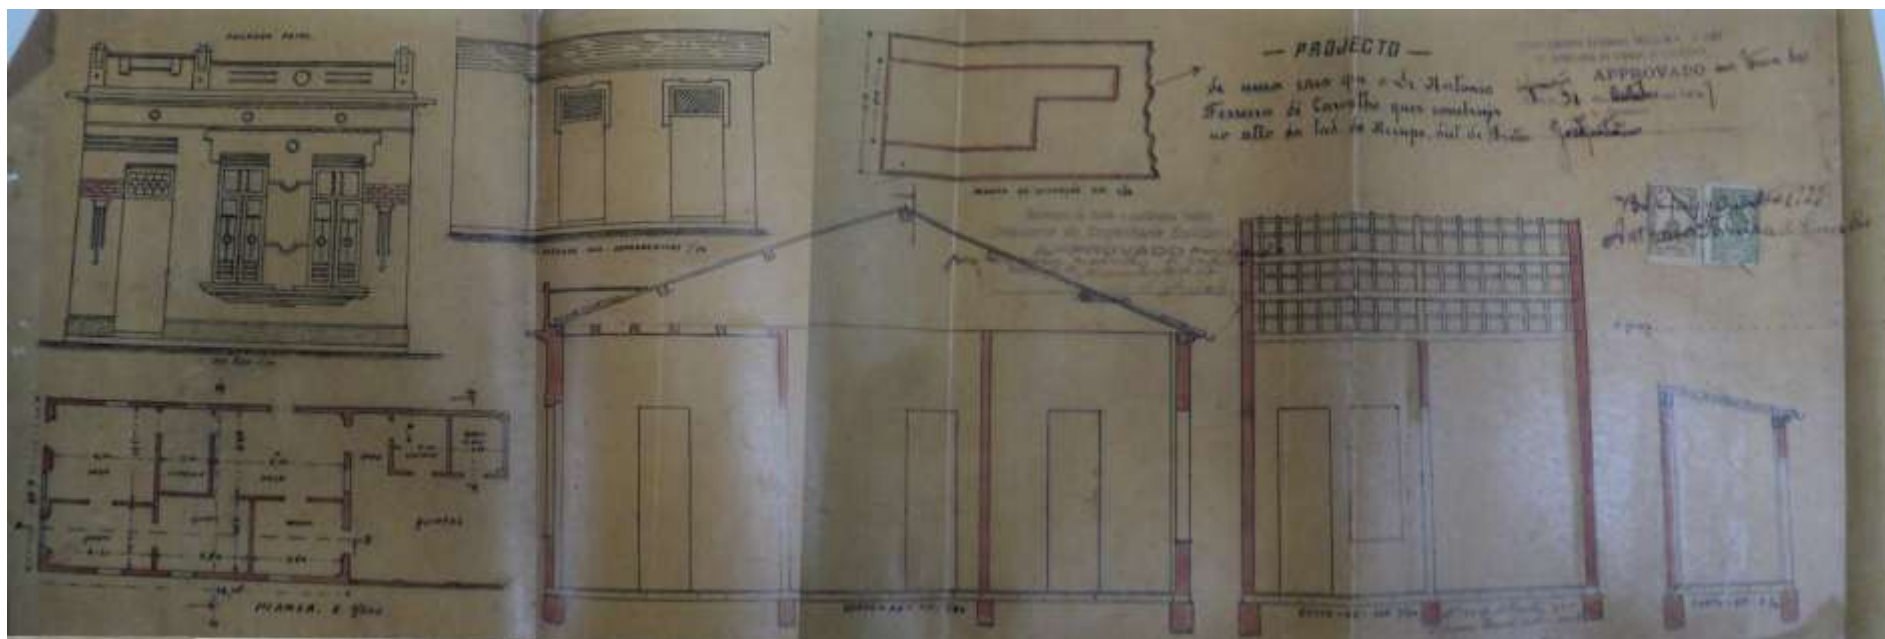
Conjunto posterior a Lei 1146/1926, mostra planta de situação Projeto para o distrito de Brotas apresentado em 1927. Acima ao centro, a planta de situação esquemática. Fotografia de peça gráfica em papel do arquivo da Fundação Gregório de Matos, 2011.
